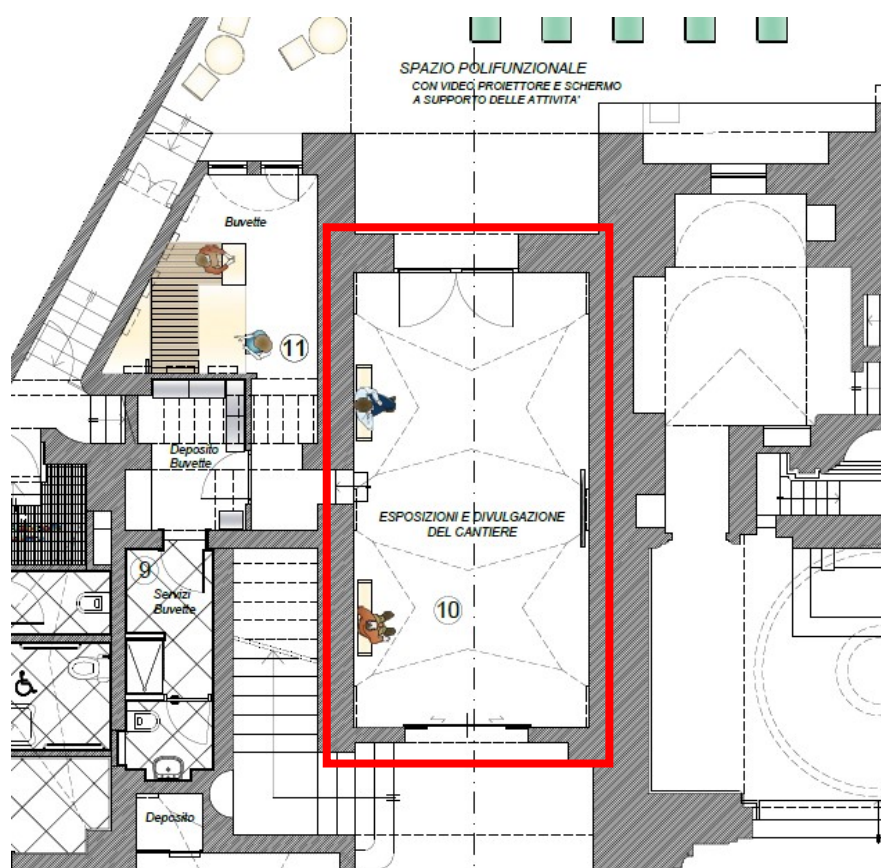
Stralcio della planimetria del piano terra con individuazione dello spazio di invito (rosso)
